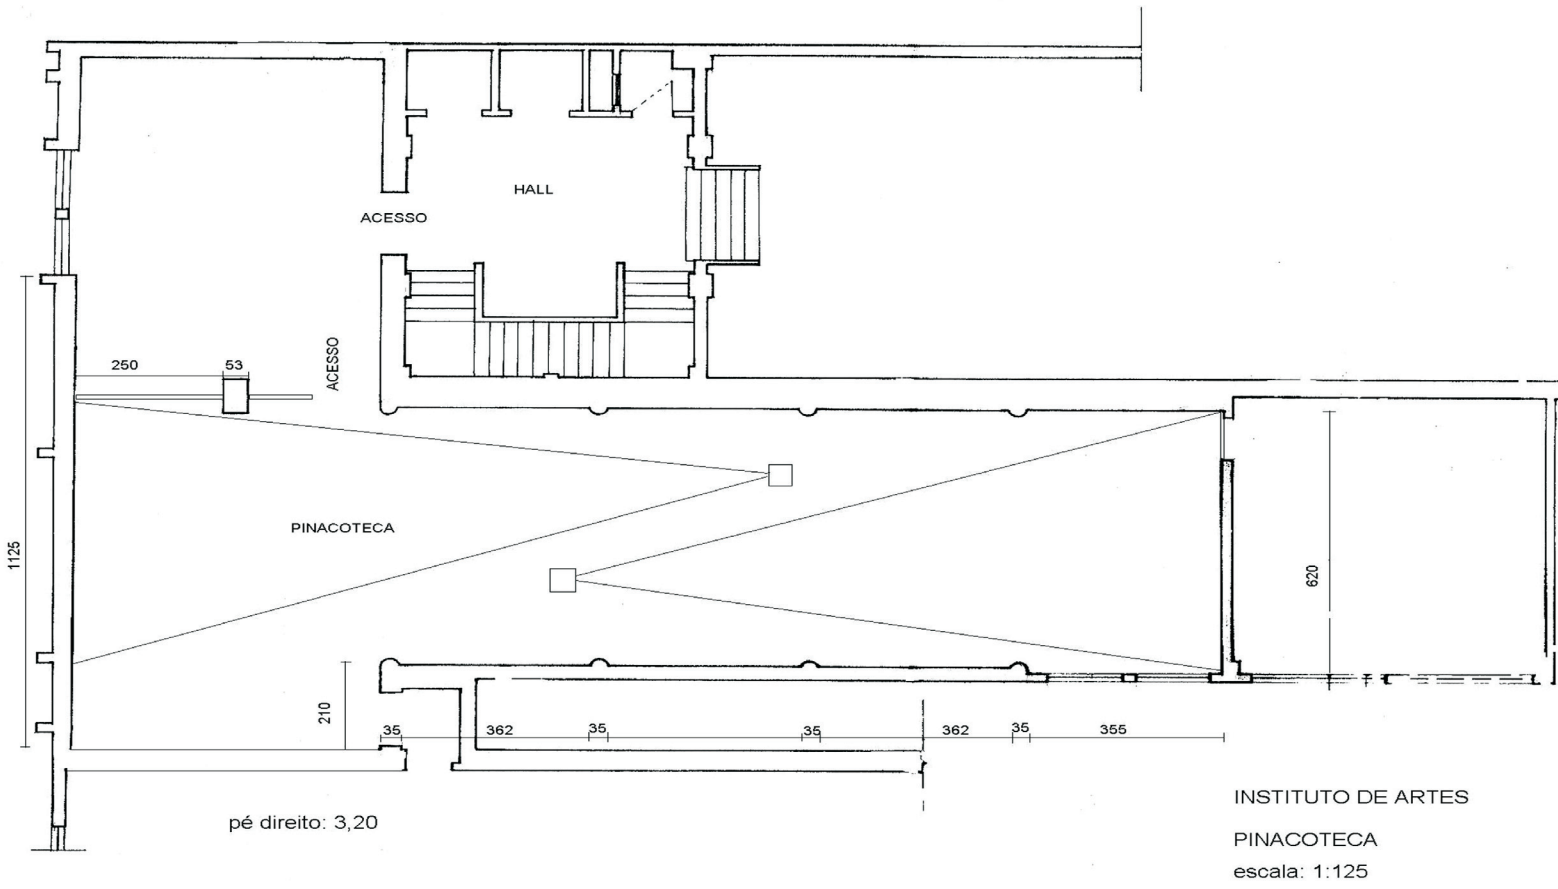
Planta baixa. Pinacoteca Instituto de Artes UFRGS.
